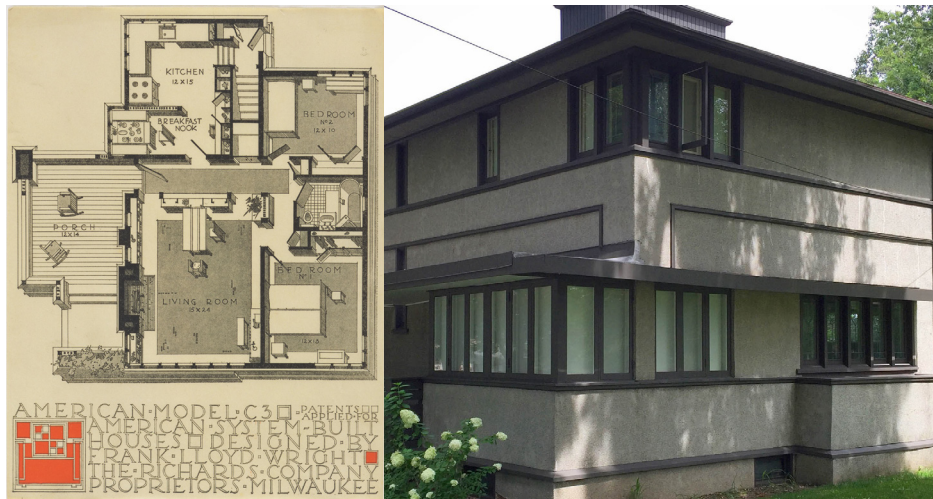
Póster The American System-built Houses fig. 9 Vivienda construida por Frank Lloyd Wright con el sistema The American System-built Houses
